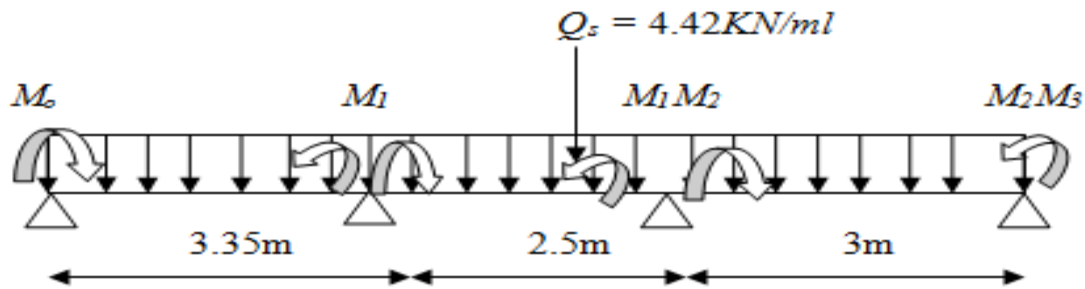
schéma statique de la poutrelle type 1 E.L.S
